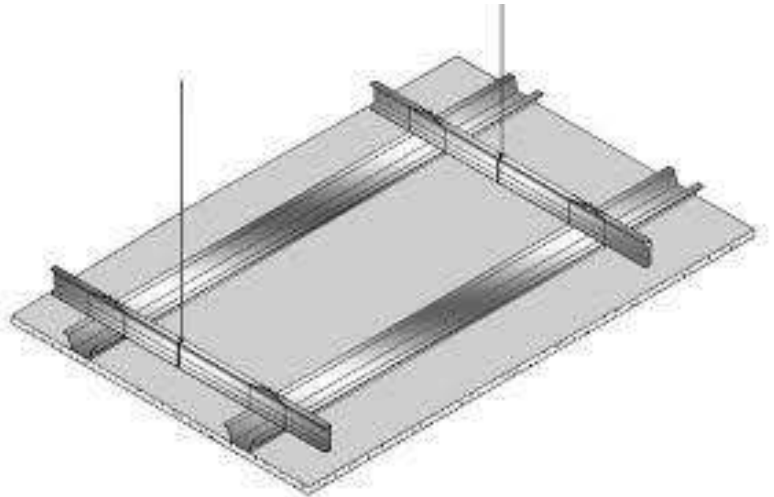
Detalle constructivo de tablaroca. www.usg.com
